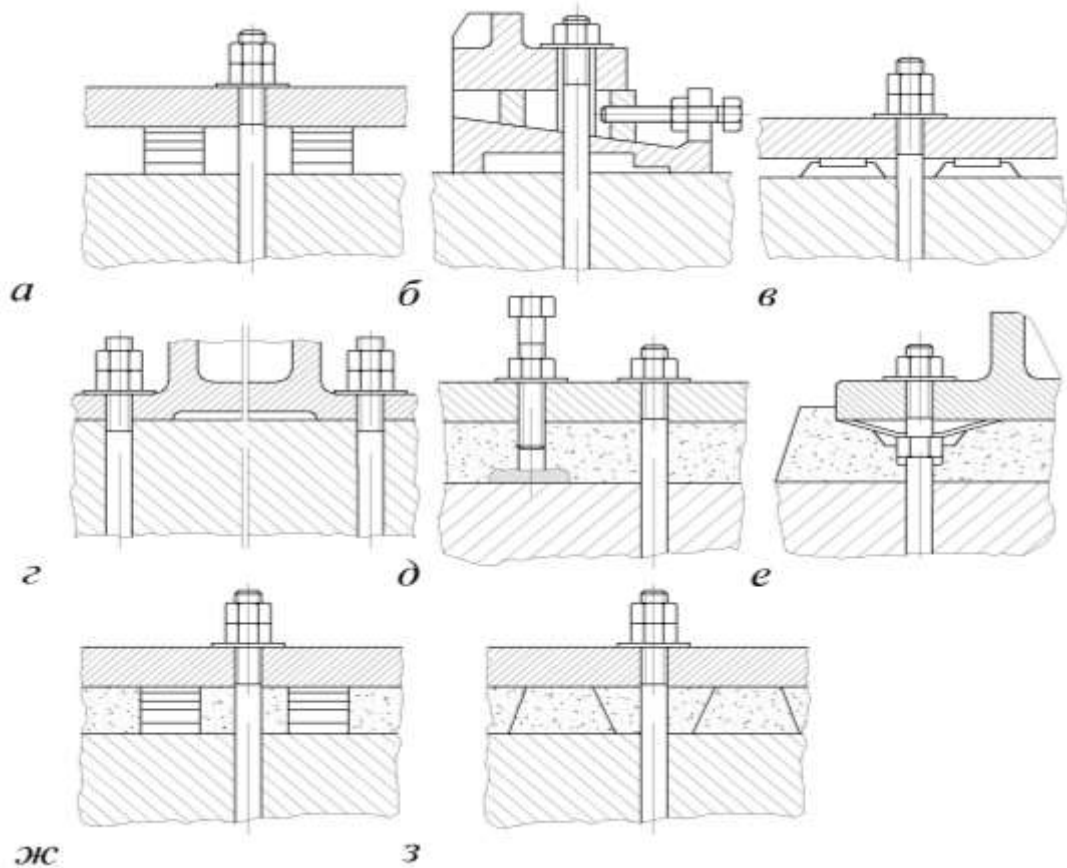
Основные конструкции стыка корпусная деталь – фундамент: с местным опиранием на пакеты подкладок (*а*), на опорные башмаки (*б*), на бетонные опоры (*в*) и непосредственно на фундамент (*г*); со сплошным опиранием на бетонную подливку с временной установкой при выверке на отжимных винтах (*д*) и на установочный гайках (*е*) со смешанным опиранием на подливку и опорные элементы (*ж*, *з*)
